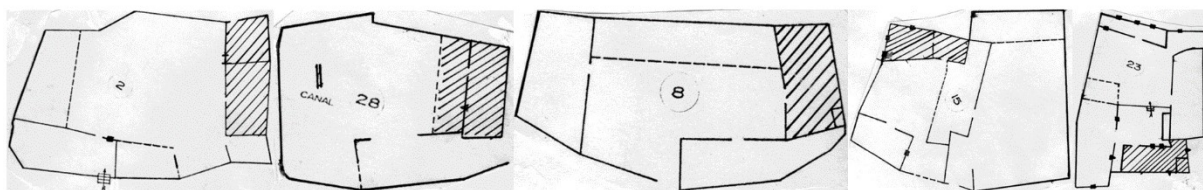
planta baixa das casas no complexo arqueológico Churajón. Fonte: Álvarez (2000)
